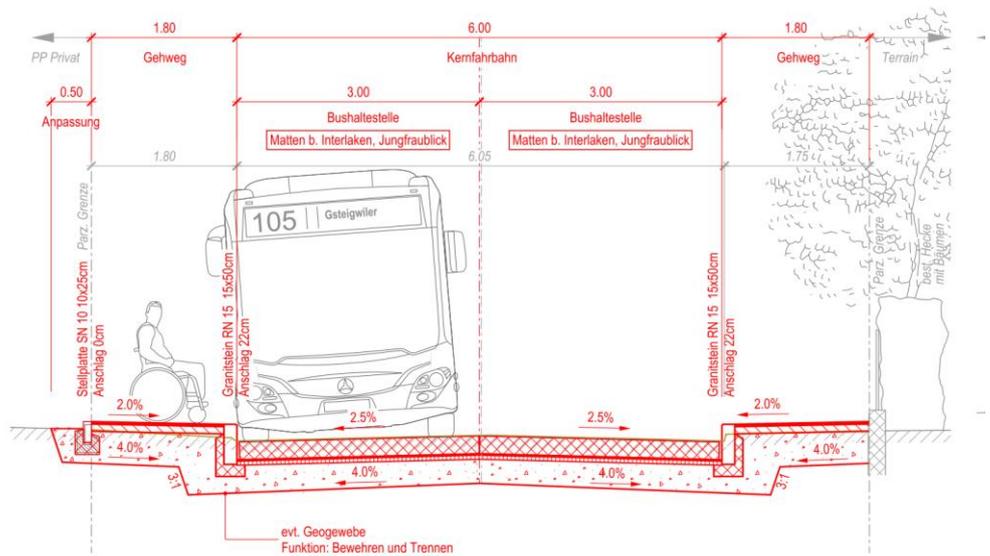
, Bushaltestelle mit Betonplatte, Planausschnitt B&H
